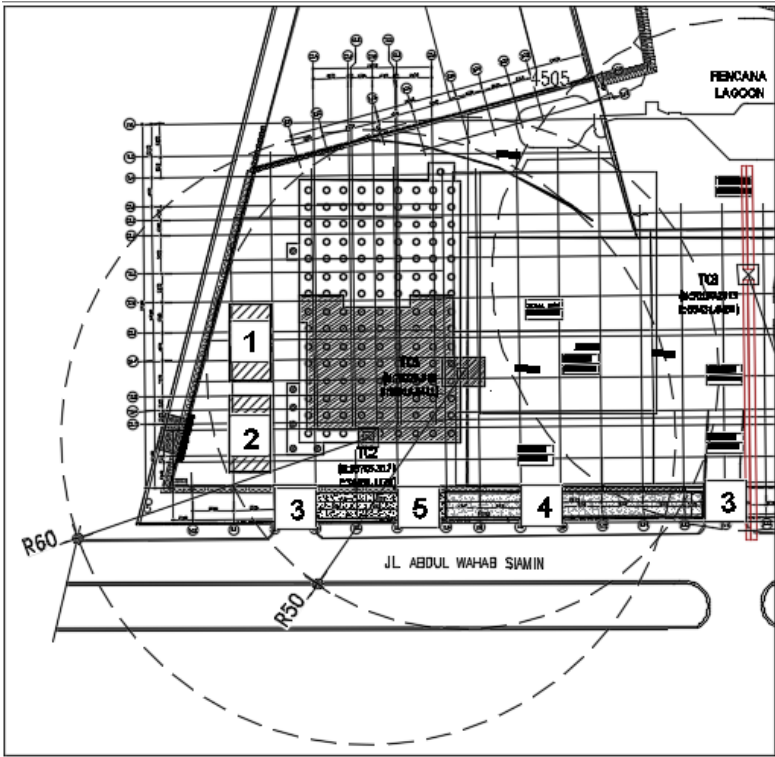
4 Site Layout Eksisting Grand Sungkono Lagoon
